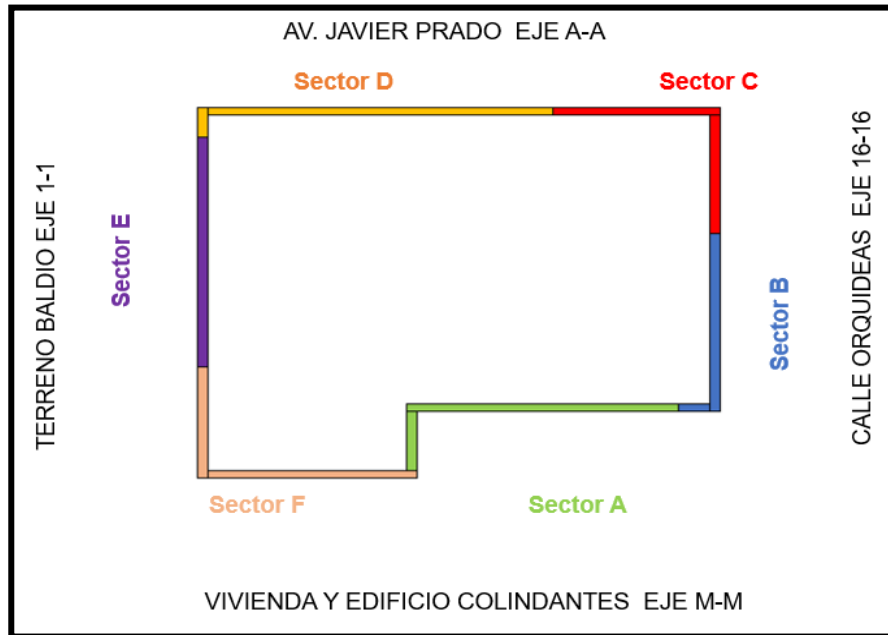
Vista en Planta de la Sectorización Muros Pantalla
